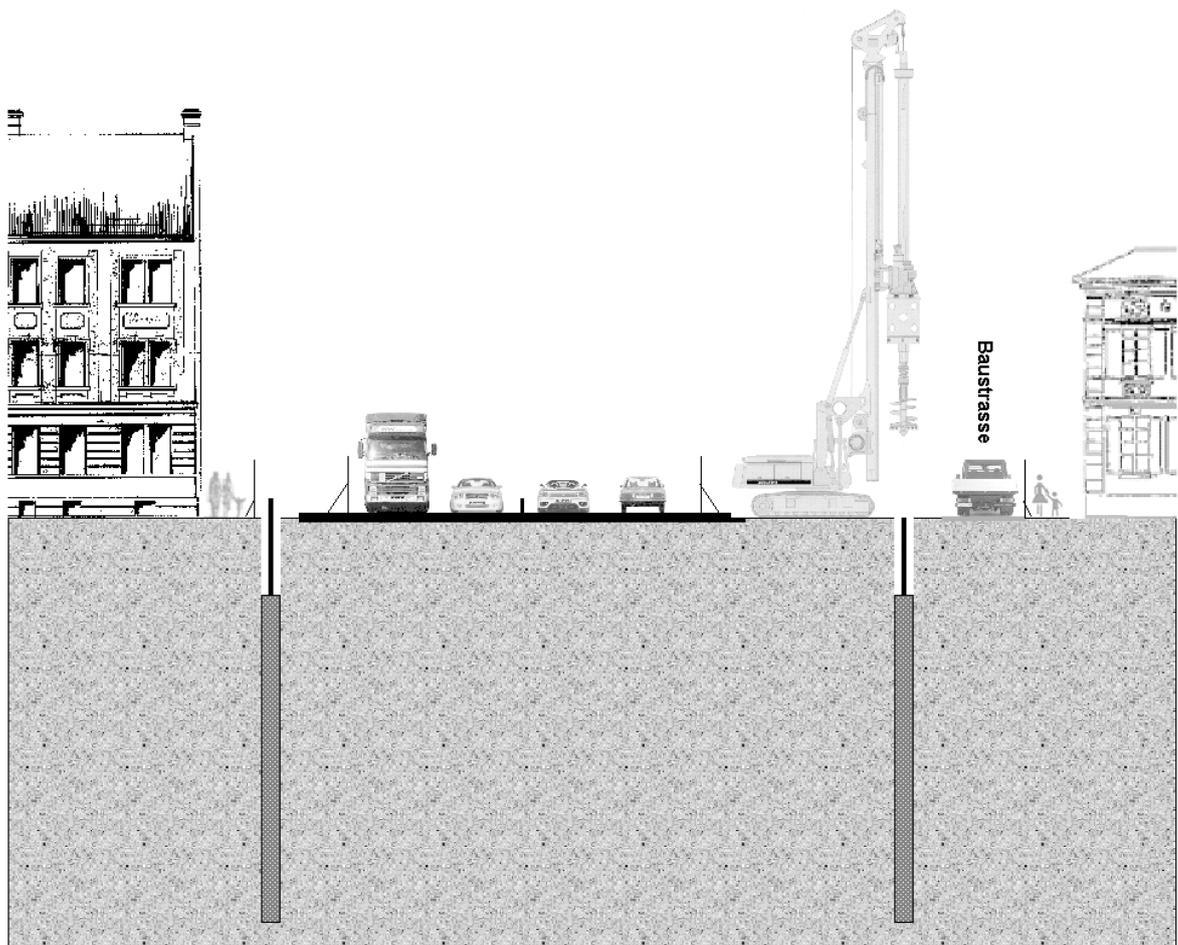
Jeweils einseitige Herstellung der Baugrubenumschliessungswände
